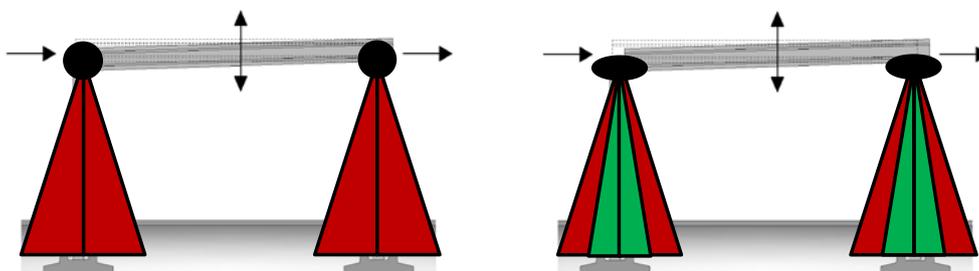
Riduzione delle sollecitazioni alla base del pilastro rispetto ad un collegamento rigido tra trave e pilastro
